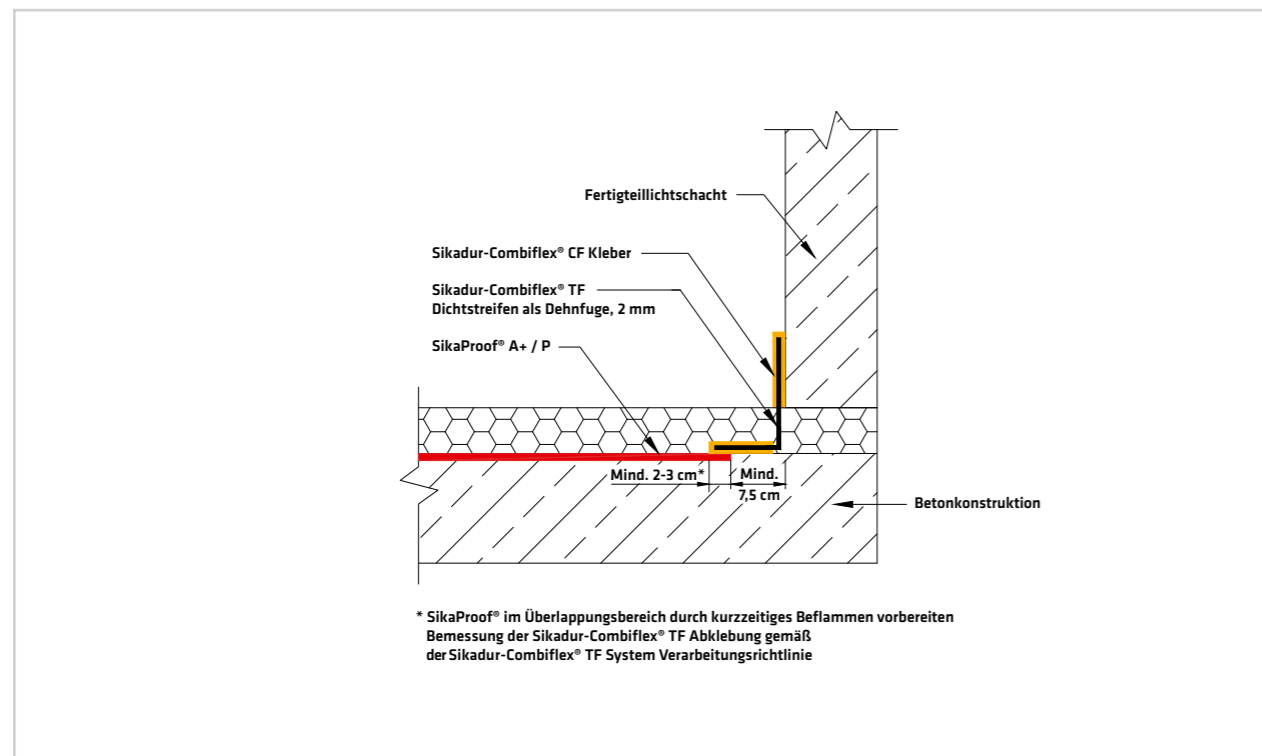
Anbindung eines Fertigteillichtschachtes
